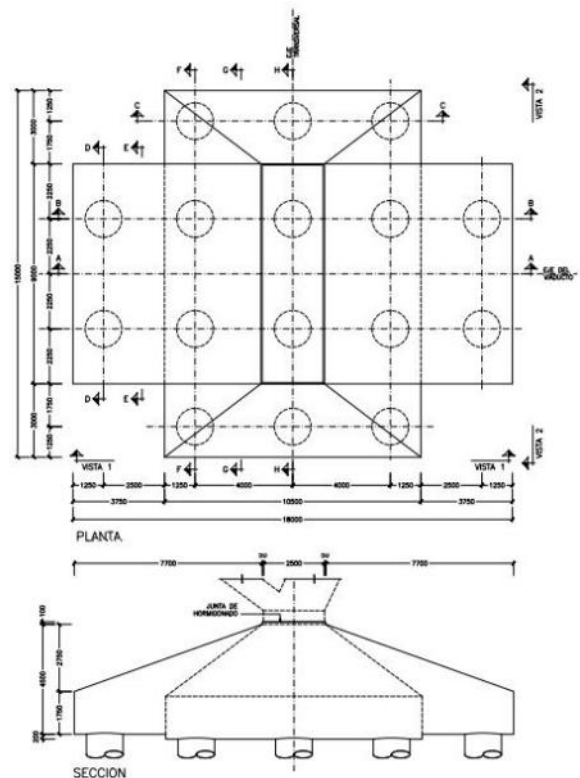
Encepado de pilas en V. Planta (arriba) y sección transversal (abajo)
